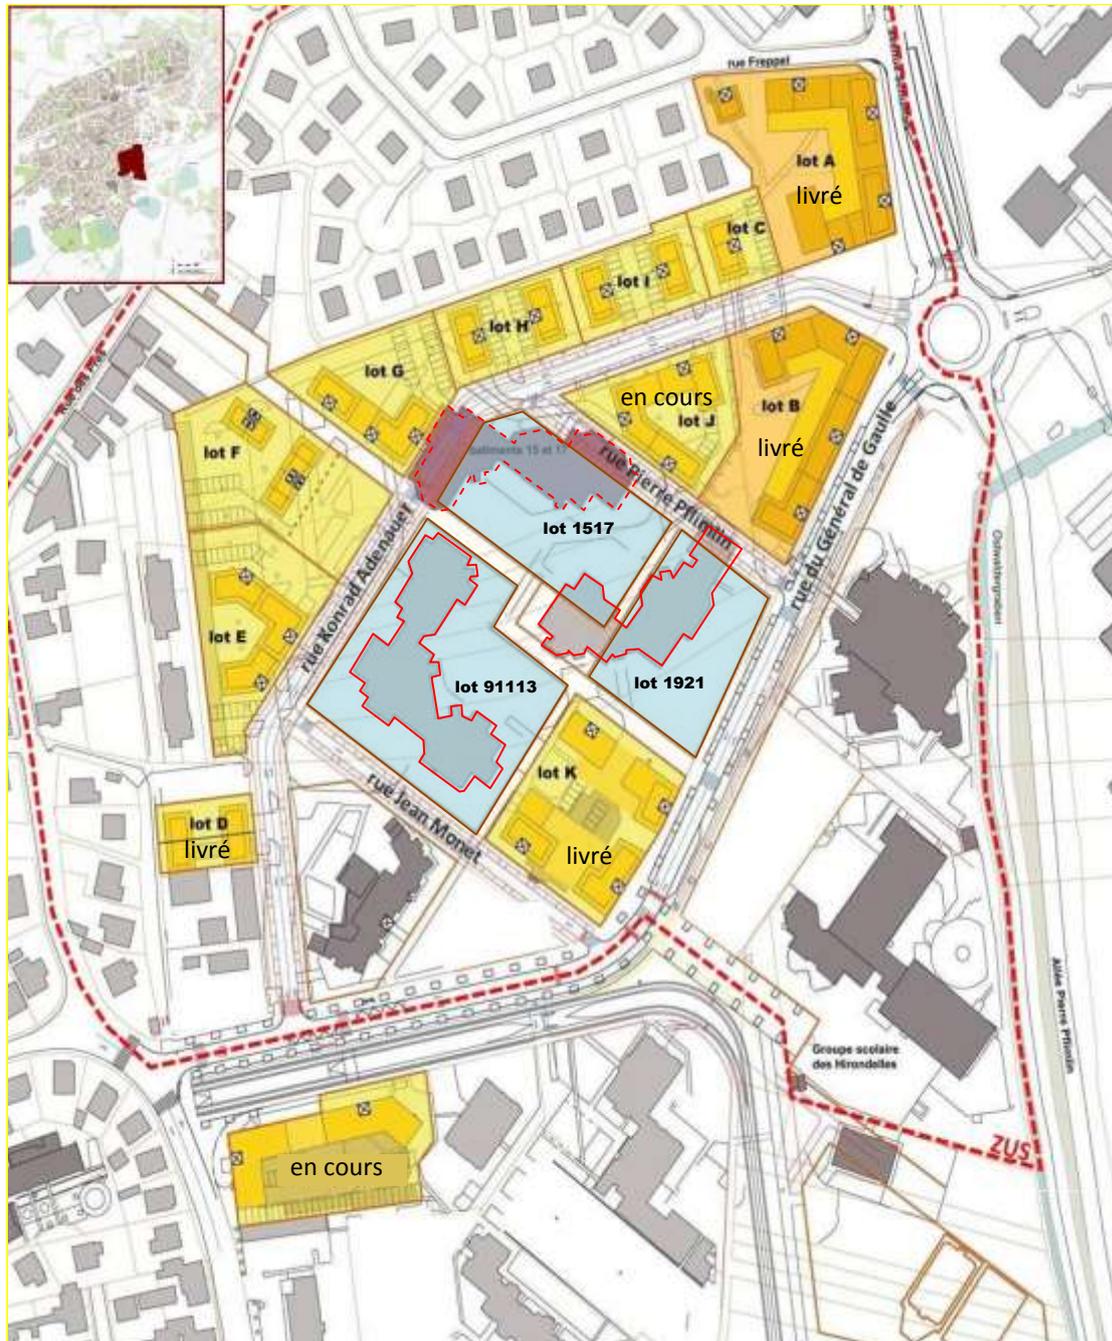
Plan de situation des secteurs dédiés au PRU (*extrait de la convention*)
